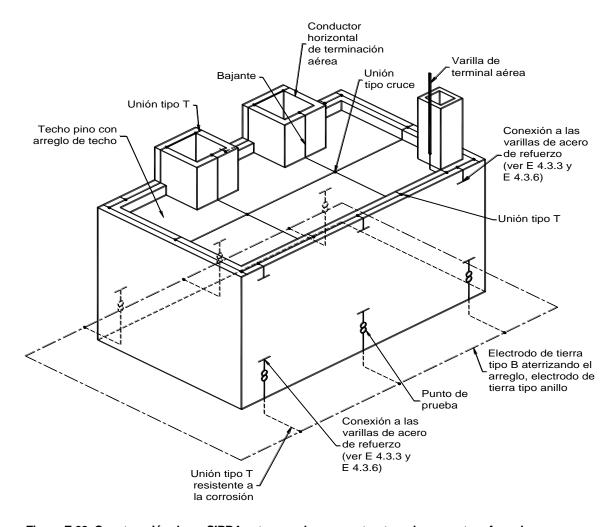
Construcción de un SIPRA externo sobre una estructura de concreto reforzada con acero usando el refuerzo de las paredes externas como componentes naturales
